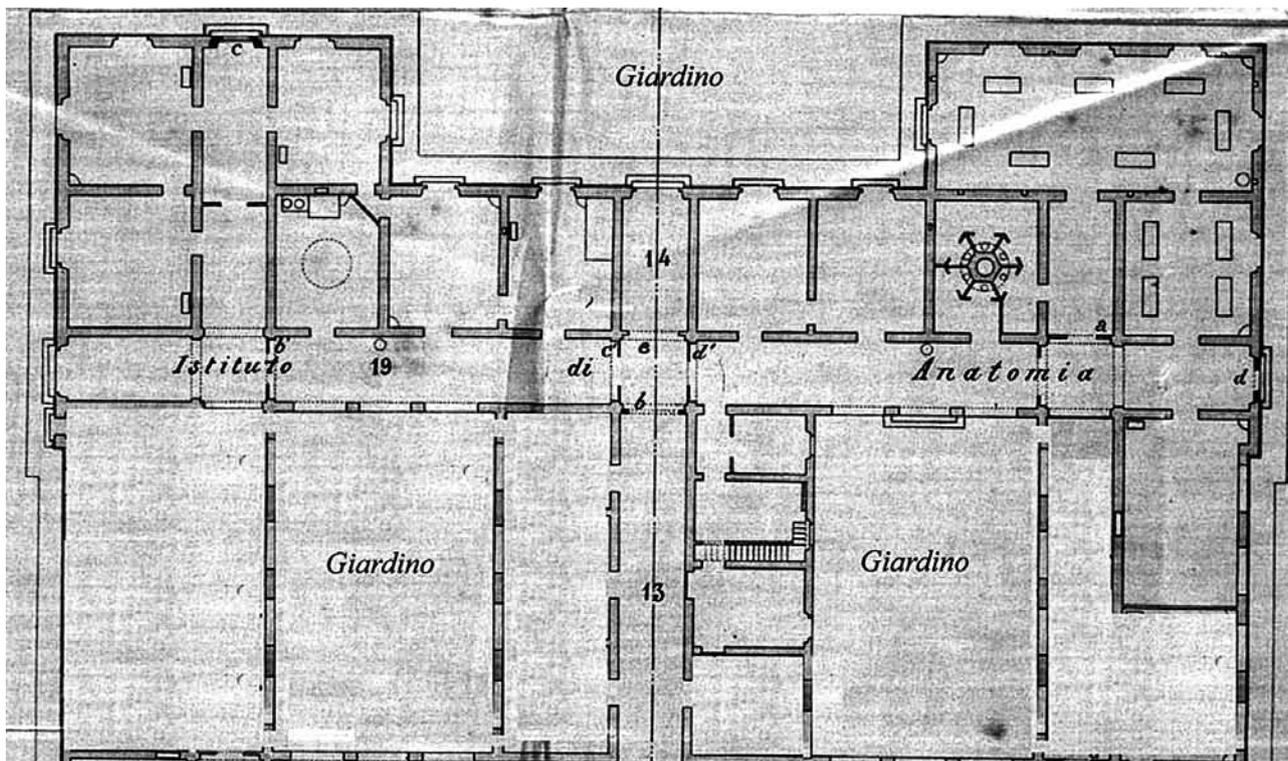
Planimetria dell'istituto di anatomia umana, limitato al solo piano terra, come si presentava nel 1876.
